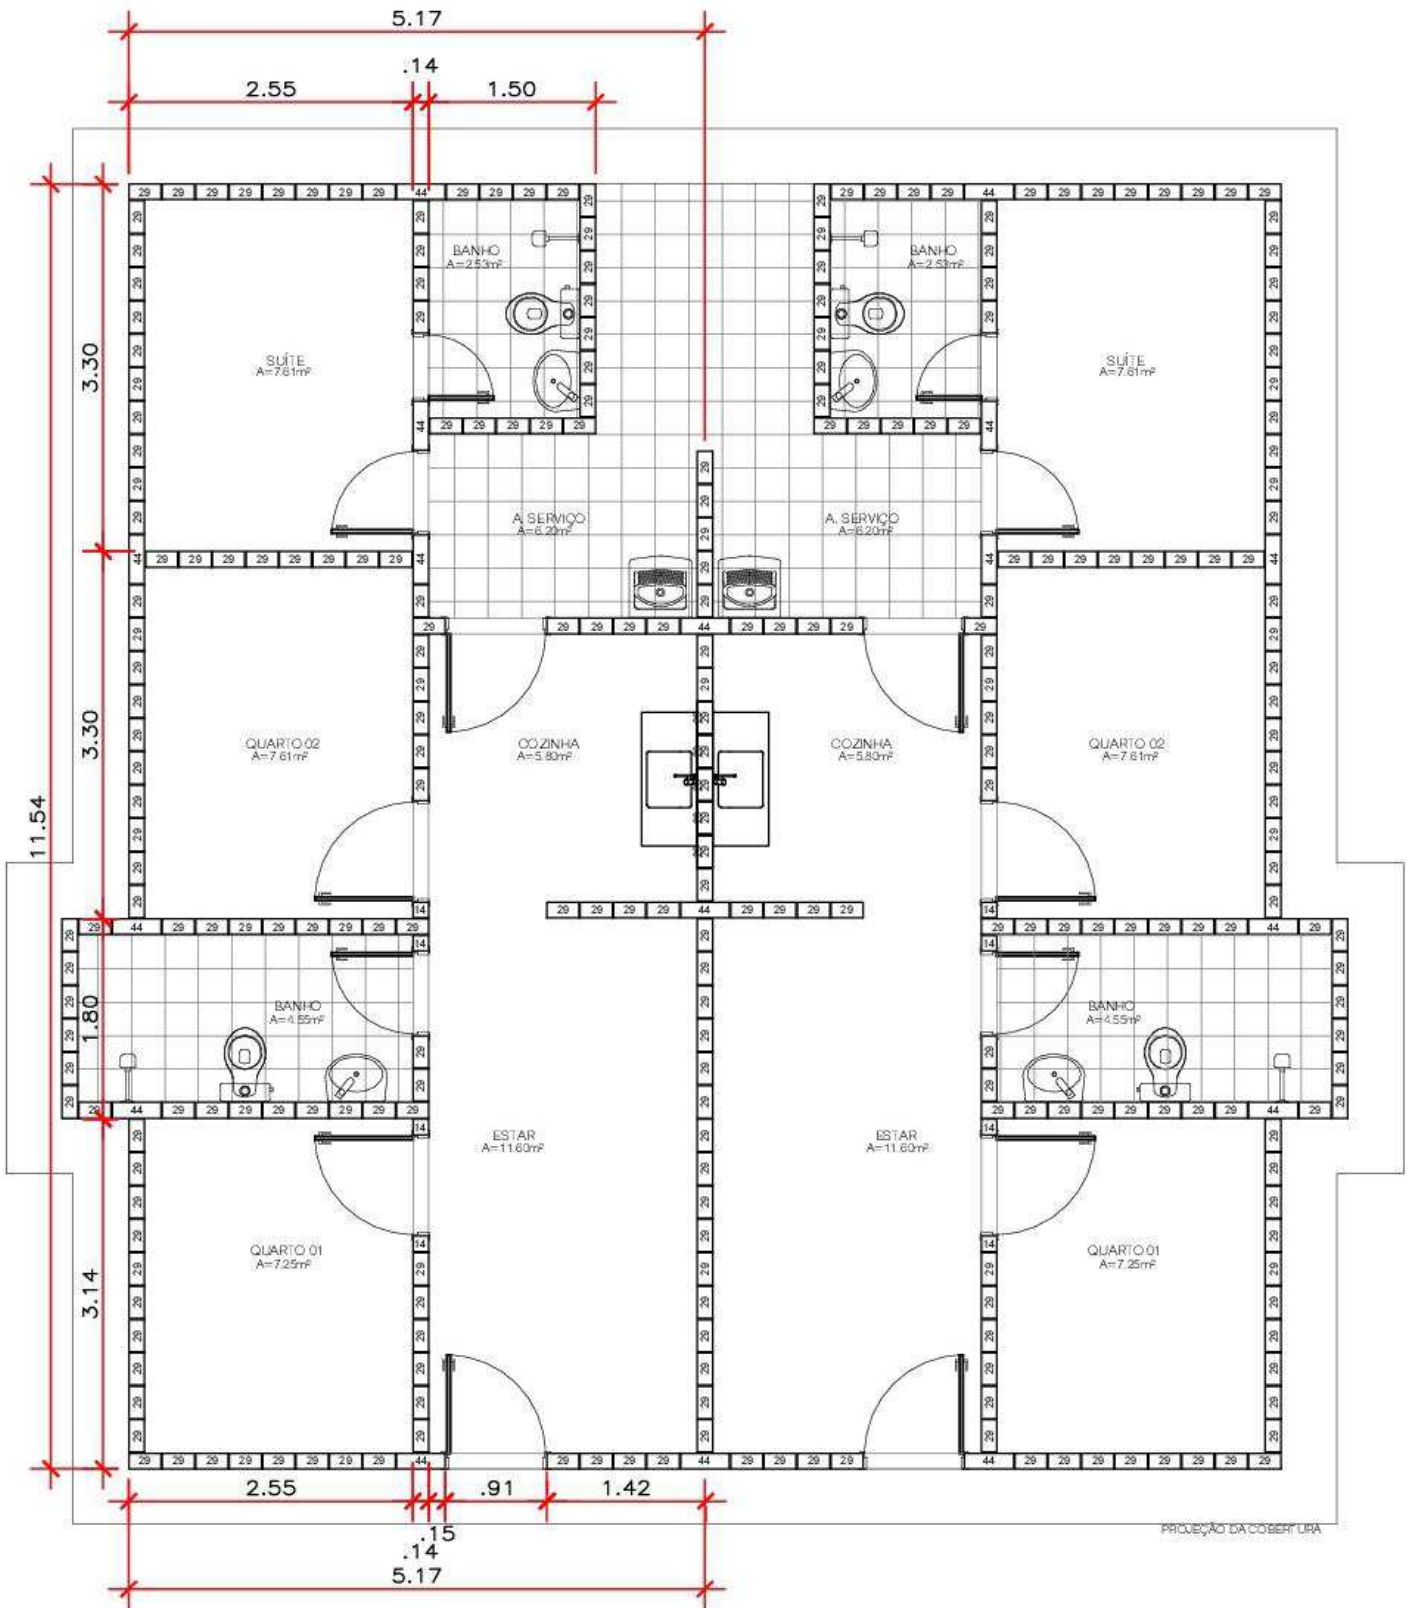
Exemplo de planta baixa de casa em padrão simples.
